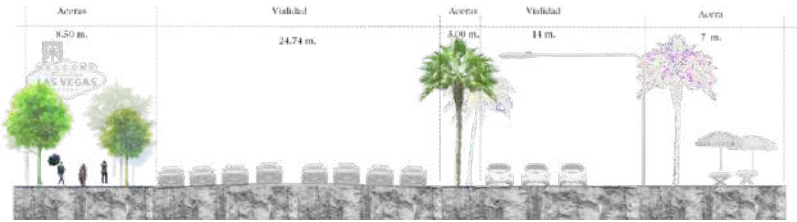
Sección vial de Las Vegas Strip, Las Vegas.
